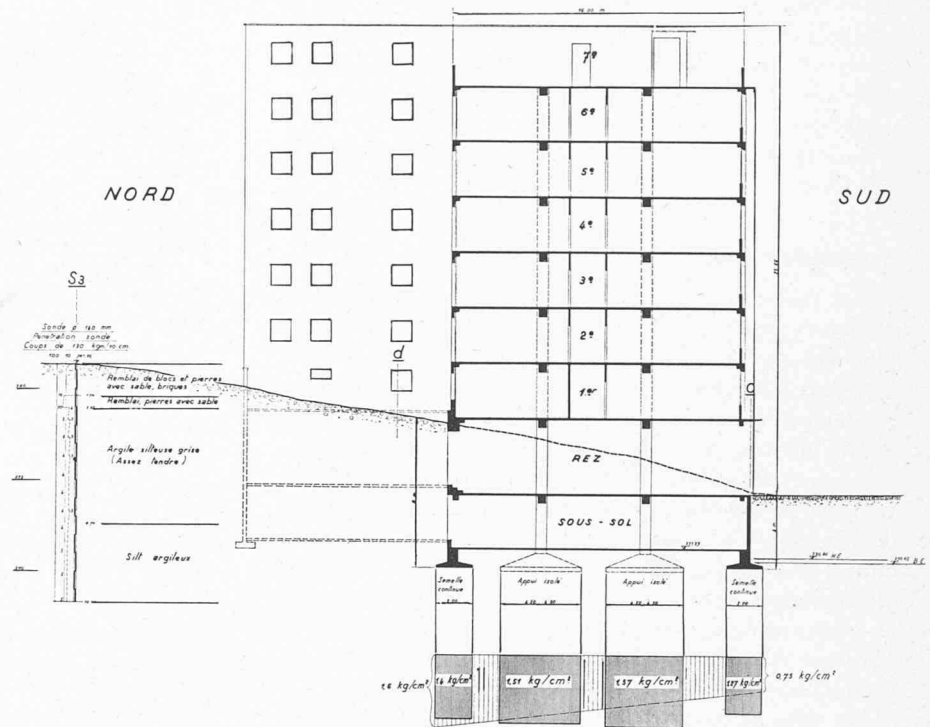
Coupe schématique $a-a$ du bâtiment et taux de travail des fondations. Sous les façades semelles continues, sous les piliers semelles rectangulaires discontinues. A gauche, sondage et essai de pénétration.
